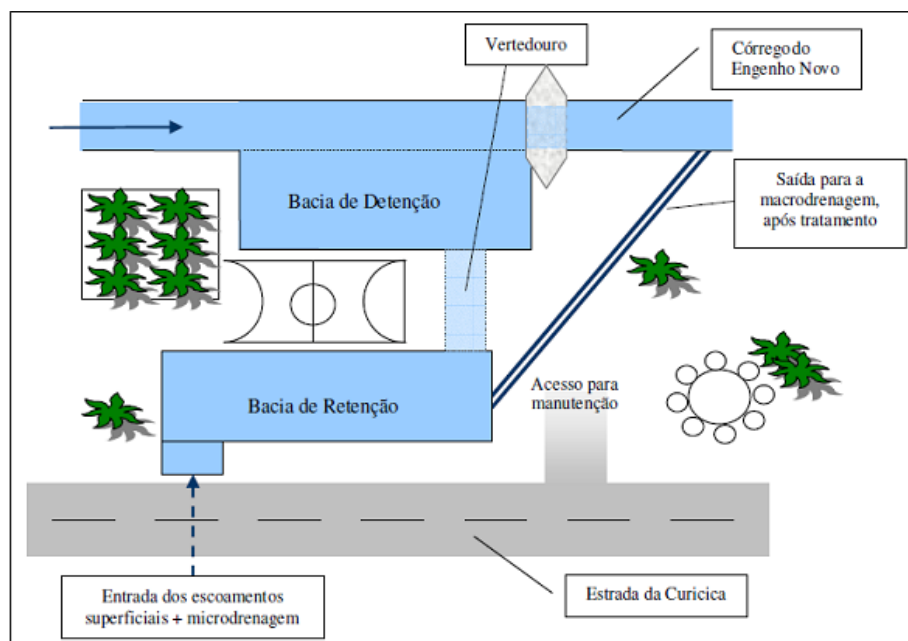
Layout esquemático dos reservatórios de detenção e retenção
